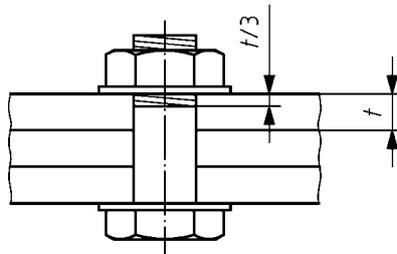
Gewindeanteil des Schraubenschaftes im auf Lochleibung beanspruchten Blech bei Passschrauben
